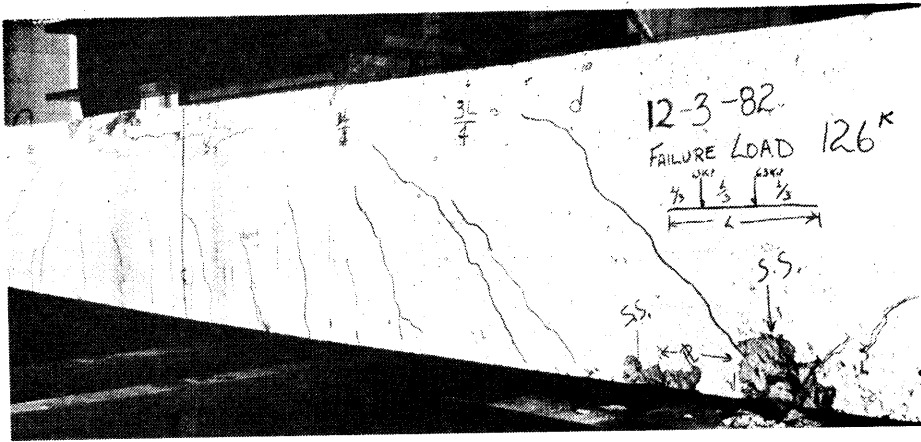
Perilaku struktural balok beton bertulang. (Tes oleh Nawy dkk.)
